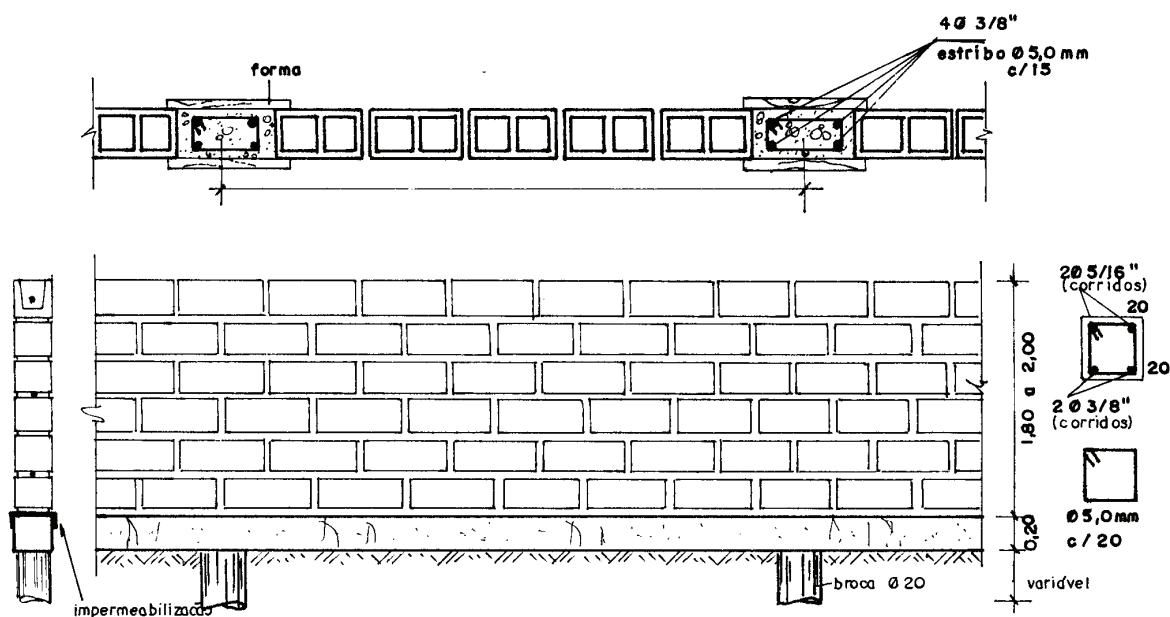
Detalhe da elevação de muro de bloco aparente , revestido e viga baldrame
